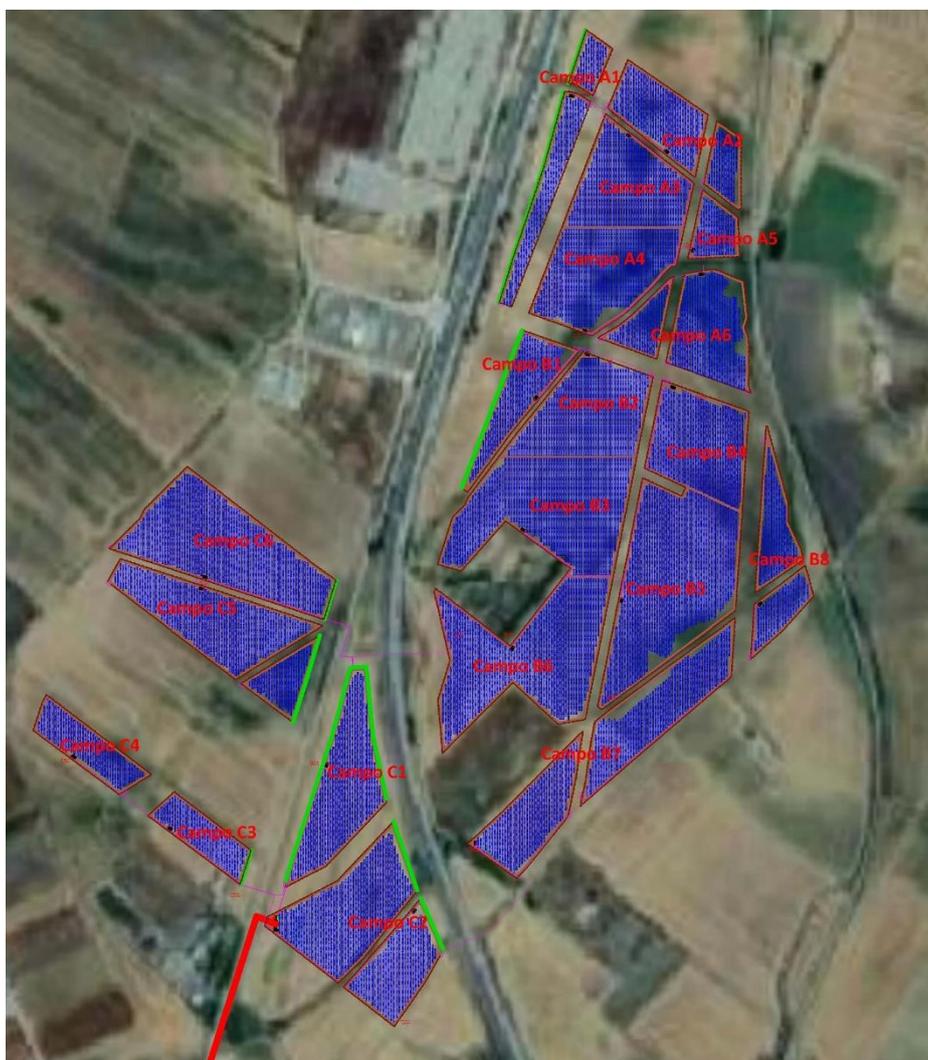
Layout del campo fotovoltaico ed individuazione sottocampi
